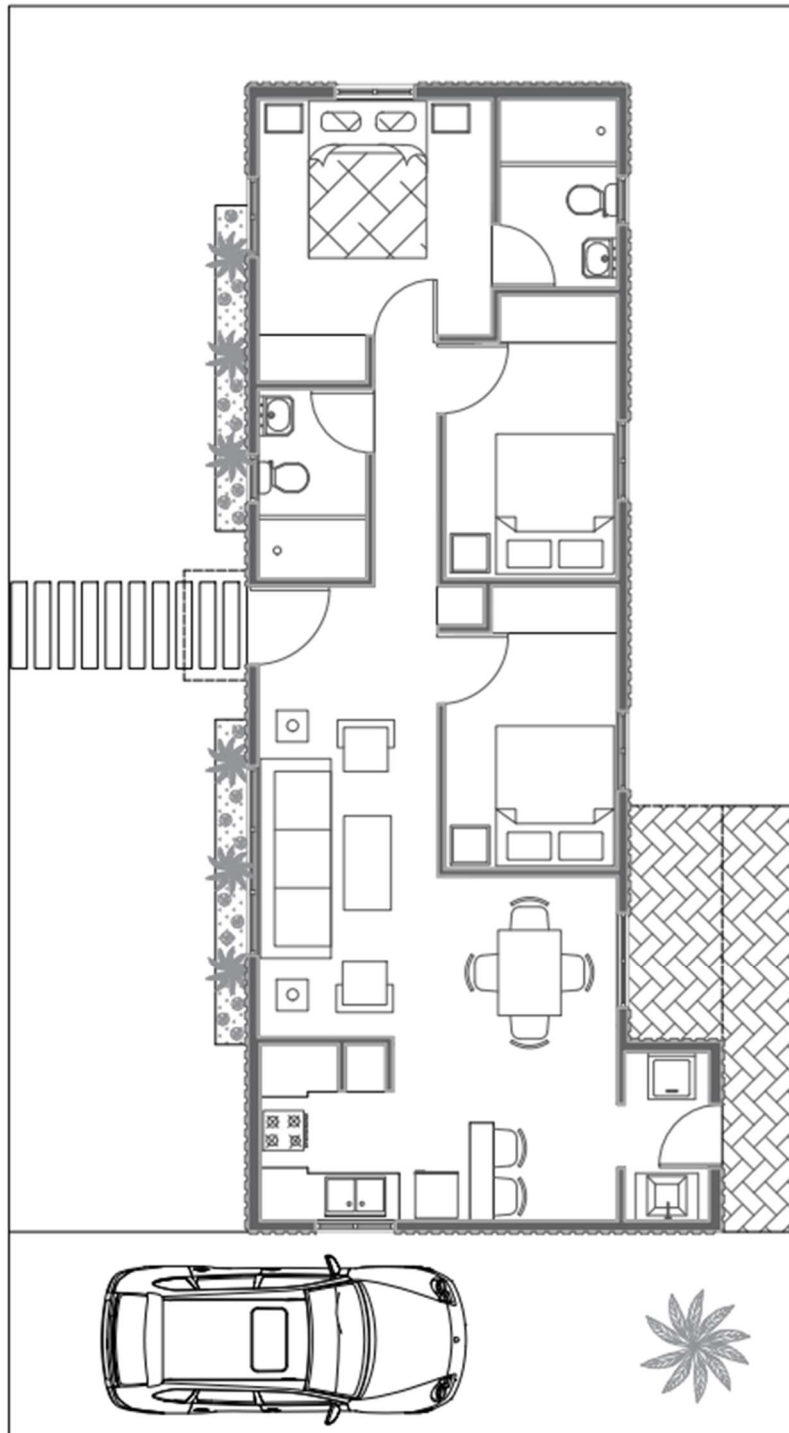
Diseño Arquitectónico – Planta Arquitectónica de Conjunto
